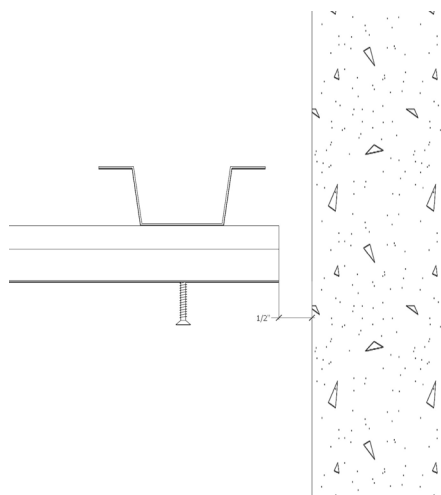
Espacement de 1/2po entre le bout des panneaux HARMONY et le mur.
